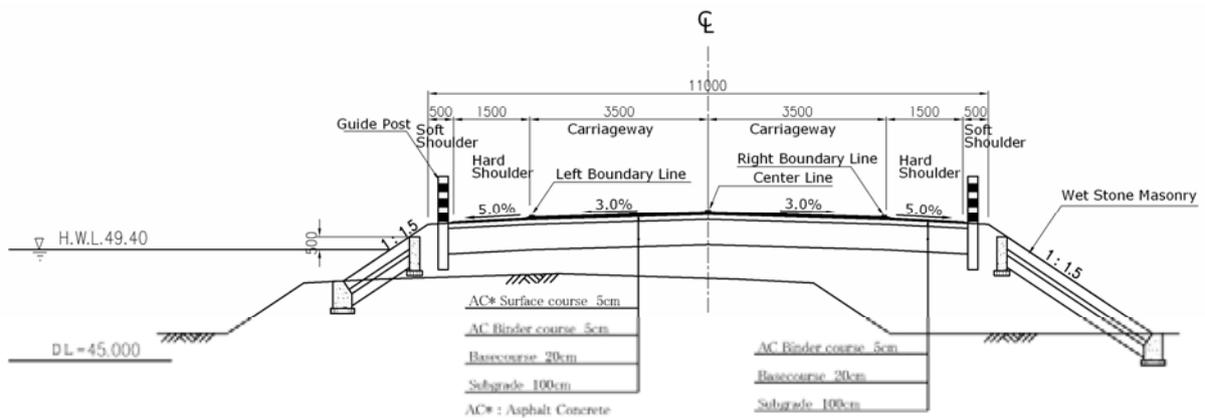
スンバ橋取付道路標準断面図
